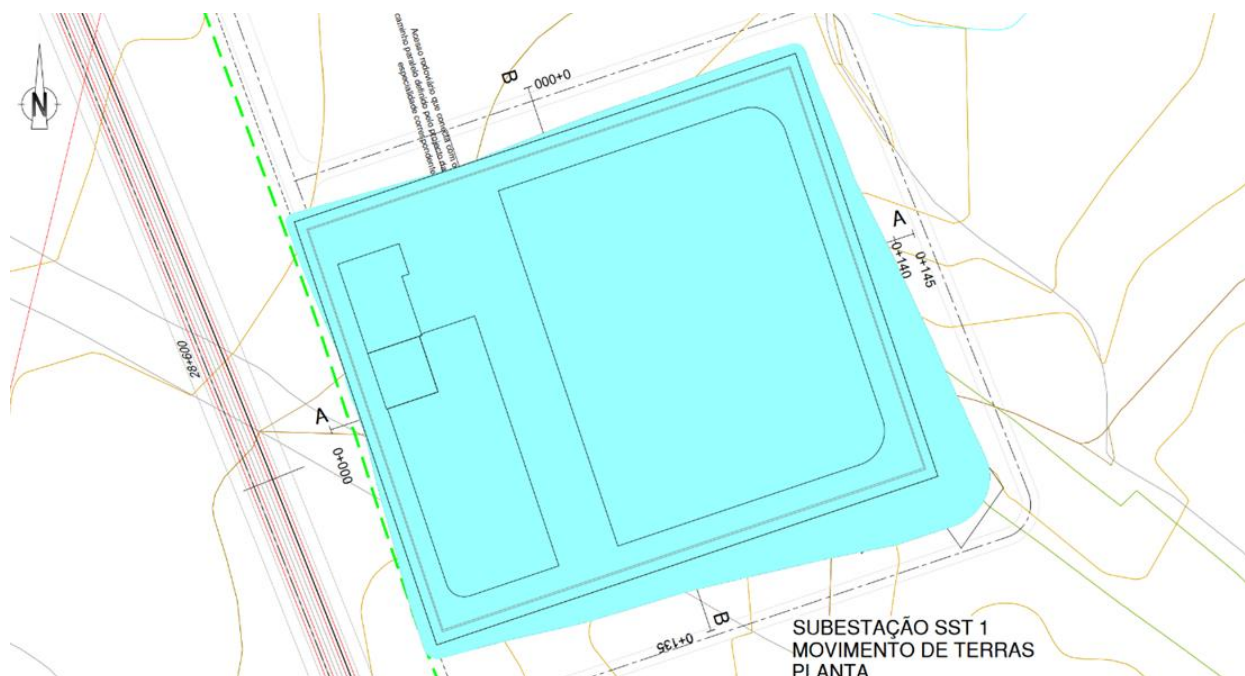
Planta Geral de Movimentos de Terra da SST1
